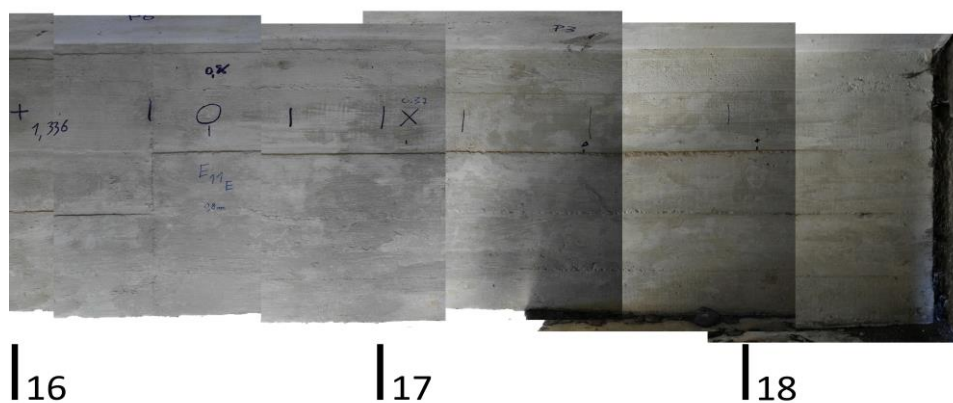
Foto da viga esquerda entre os 16 e 18,5 metros
